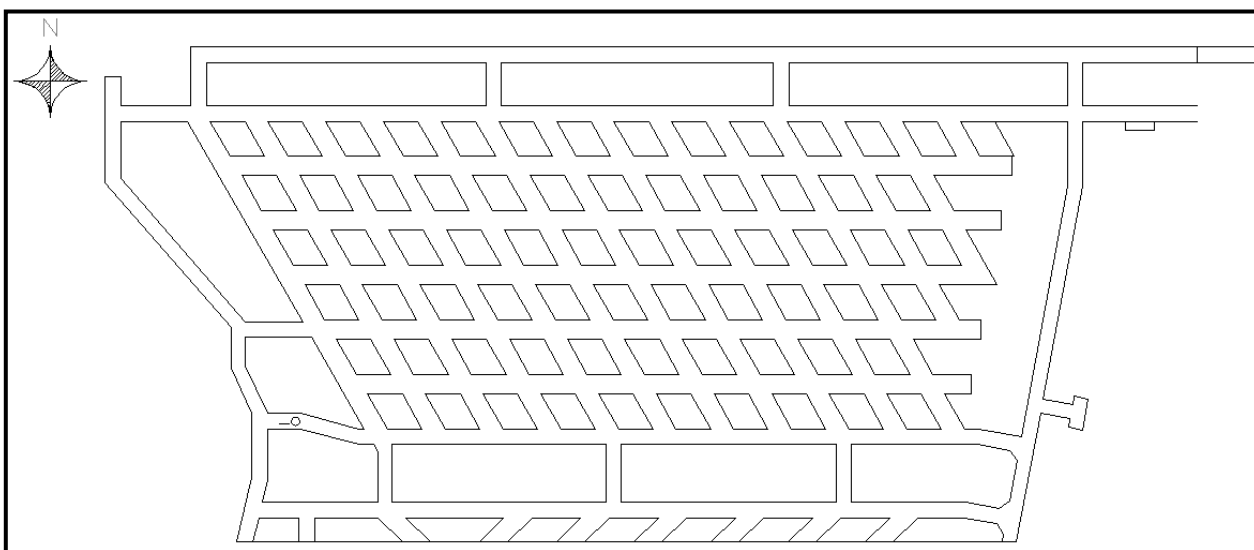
Plano en planta del diseño de proyecto para unidad extractiva.
